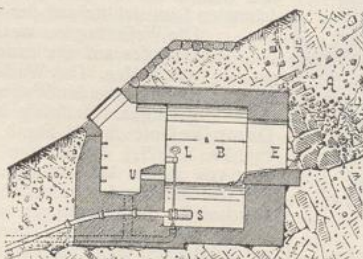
Einfache Quellenfassung. A Sandsperr. B Brunnenstube. E Einlaufschlitze. S Einlaufteiler in die Druckleitung. U Ueberlauf. L Leerlaufventile.
